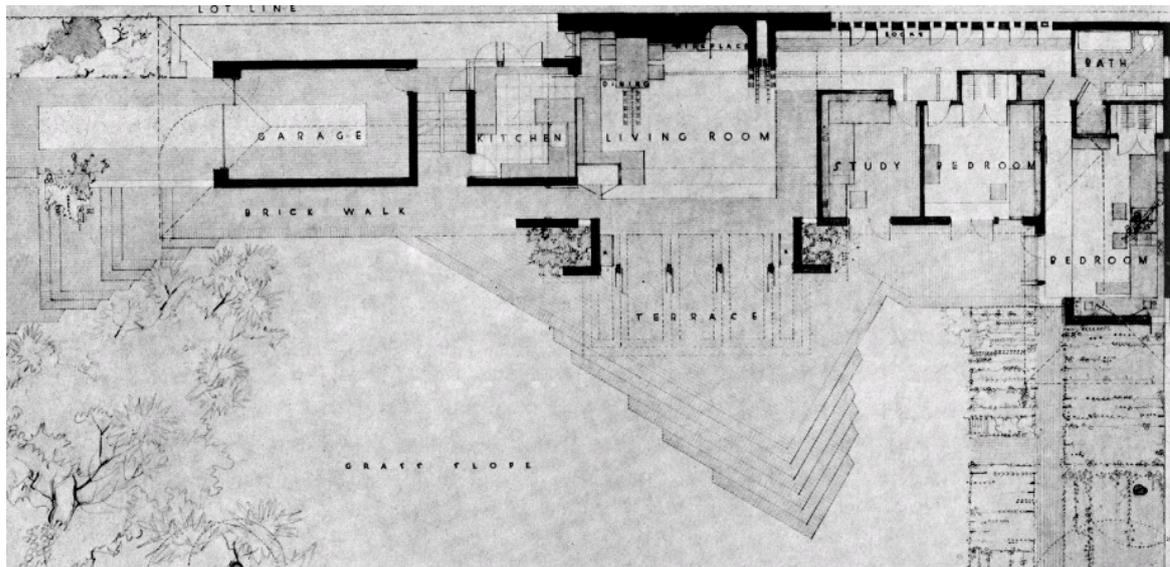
Willey House, Grundriss, Quelle: [www.medienarchitektur.at](http://www.medienarchitektur.at)
